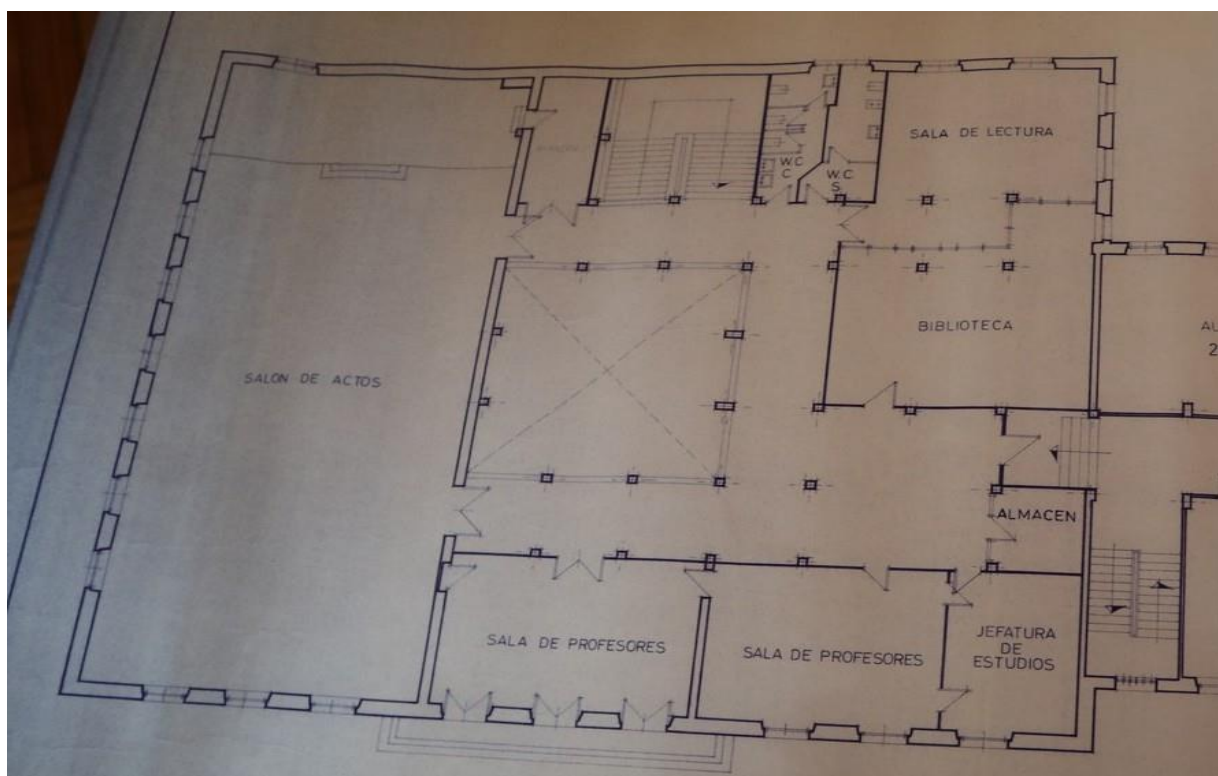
Planos de Benjamín Santín C, 1972. Bloque I de la segunda planta
